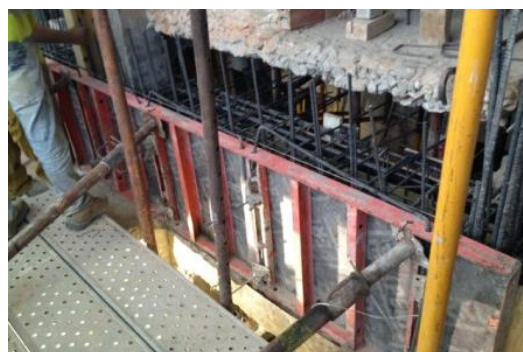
Cofragem metálica das vigas V.1.9 e V.1.10
